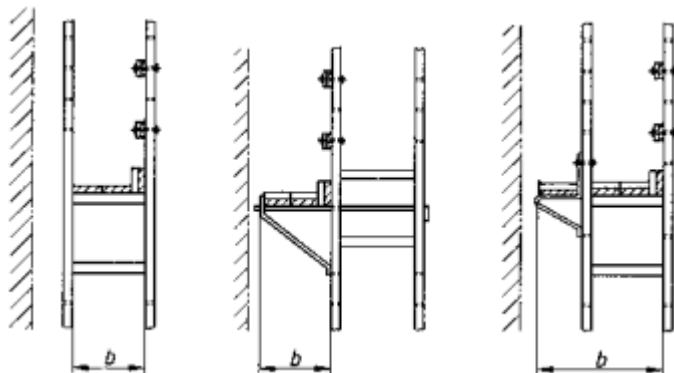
Fassadengerüst (zulässige Gerüstfeldlänge zur a , siehe Tabelle 5, zulässige Gerüsthöhen zur h , siehe Abschnitt 5.1.1 und Belagbreiten siehe Abschnitt 5.1.3)
